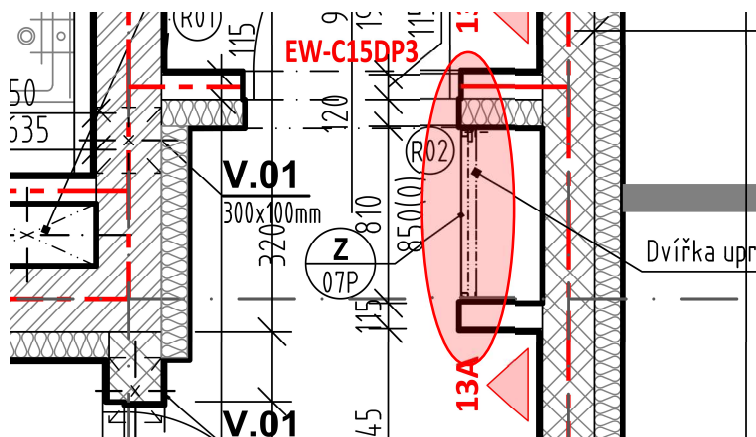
Výstřižek z půdorysu střechy VZT – kolize zabezpečovací lana a VZT potrubí
